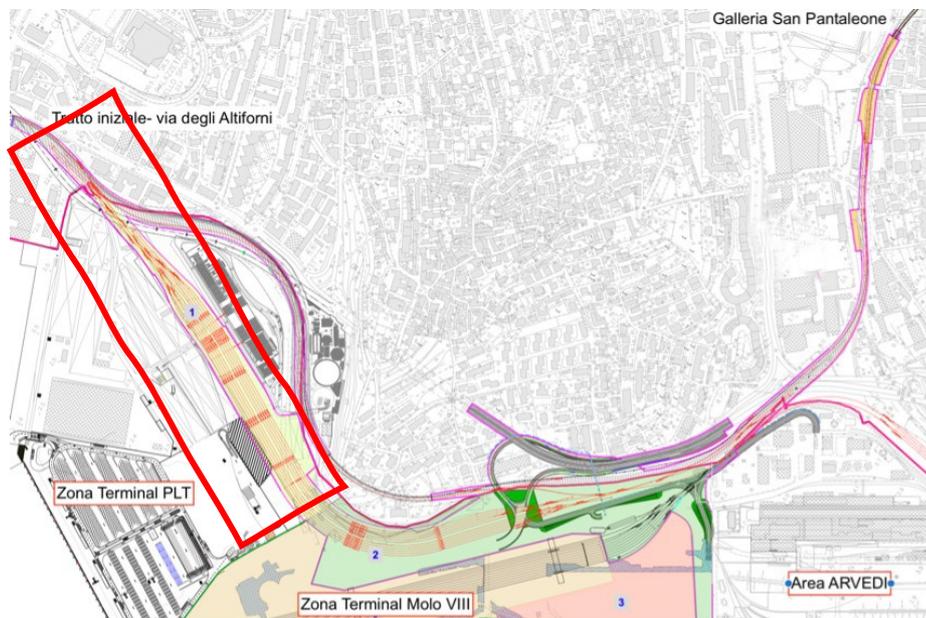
planimetria generale, con individuata la "Zona Nord"
